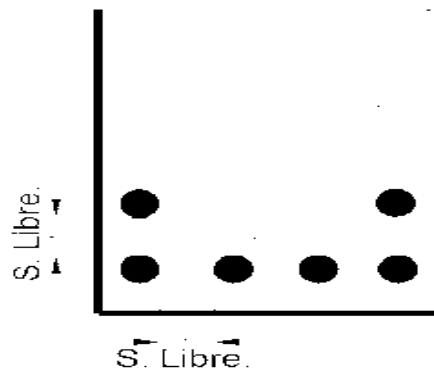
Separación libre entre barras de refuerzo longitudinal.
